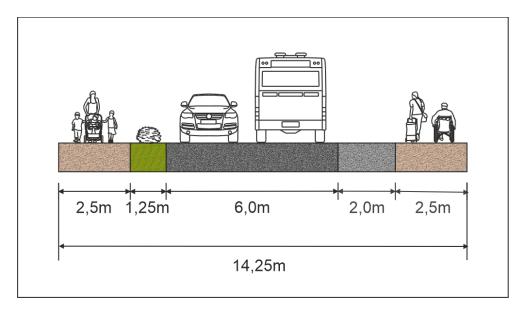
Aktueller Straßenguerschnitt der Wohnstraße Beethovenstraße (eigene Darstellung)
